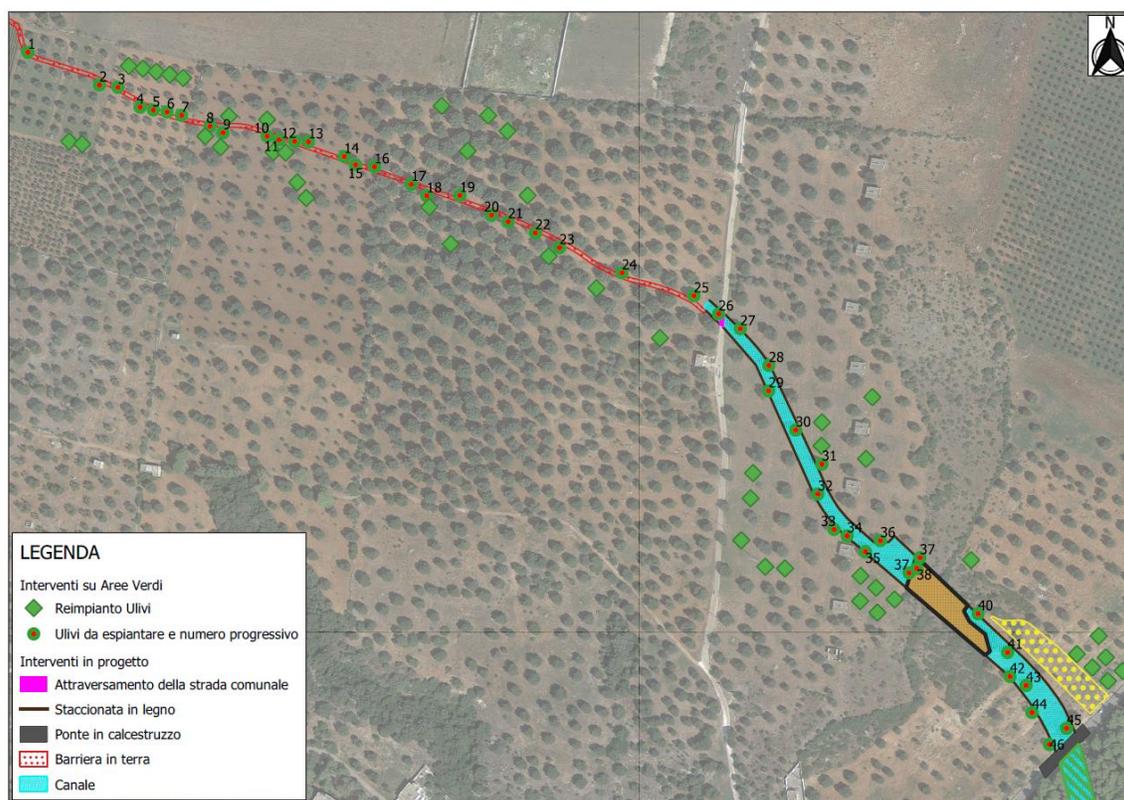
Planimetria con indicazione degli ulivi da rimuovere e ubicazione del reimpianto
